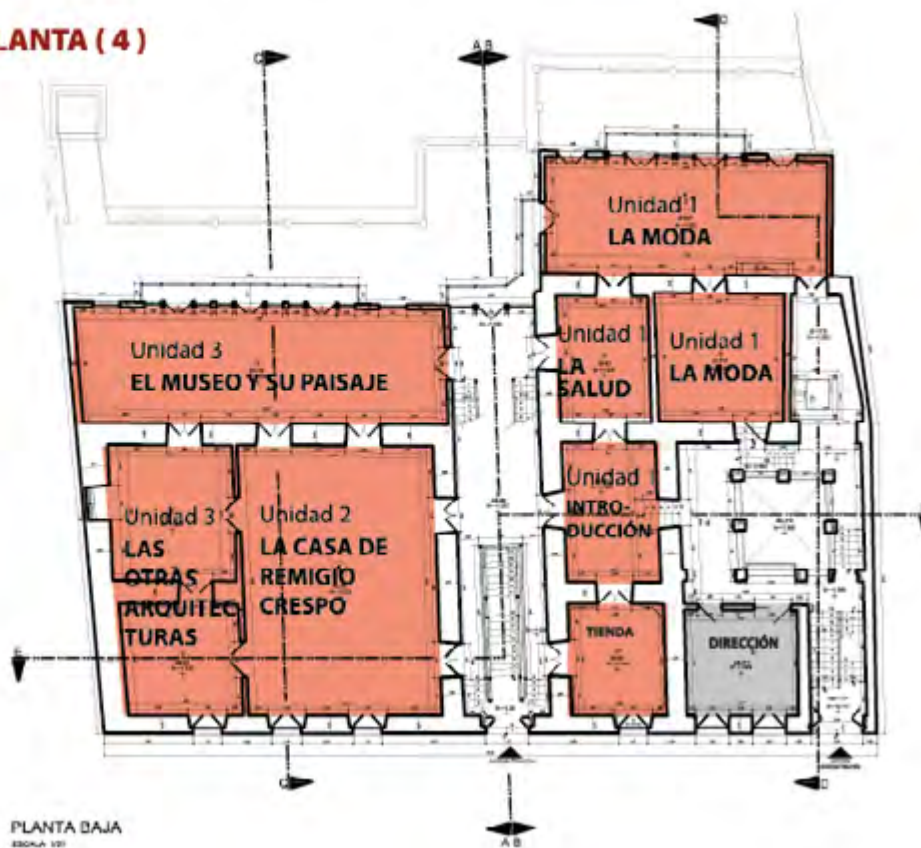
Imagen de la primera planta de la Casa museo Remigio Crespo.
